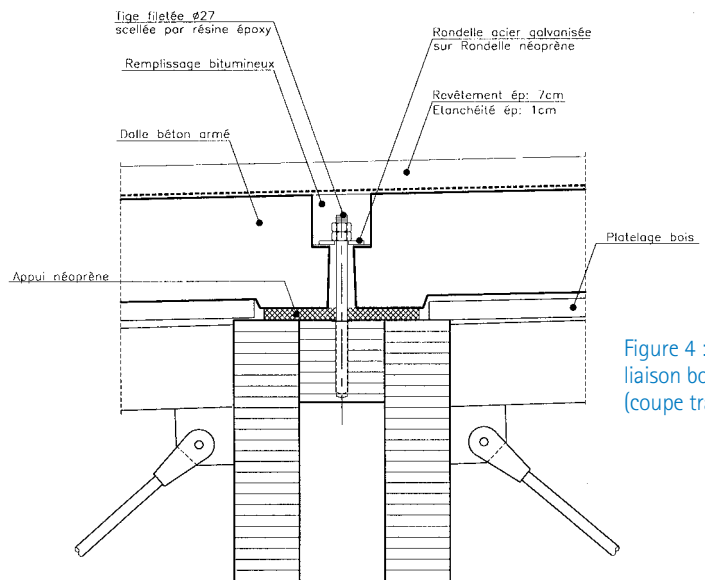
Détail de liaison bois-béton (coupe transversale).
